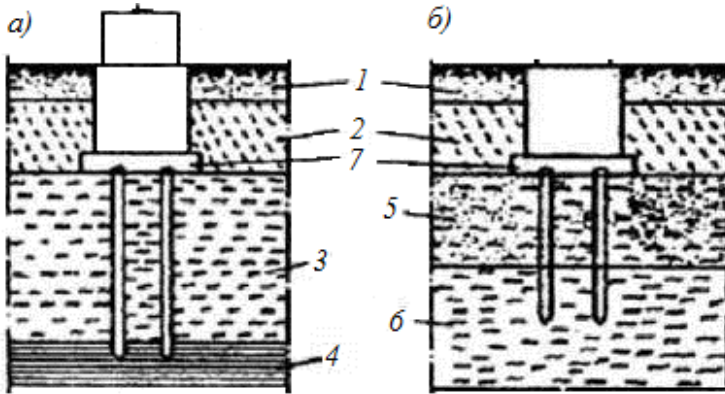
Пальові фундаменти: а – палі-стійки; б – висячі палі; 1-3, 5, 6 – шари слабких ґрунтів; 4 – щільні ґрунти; 7 – ростверк
